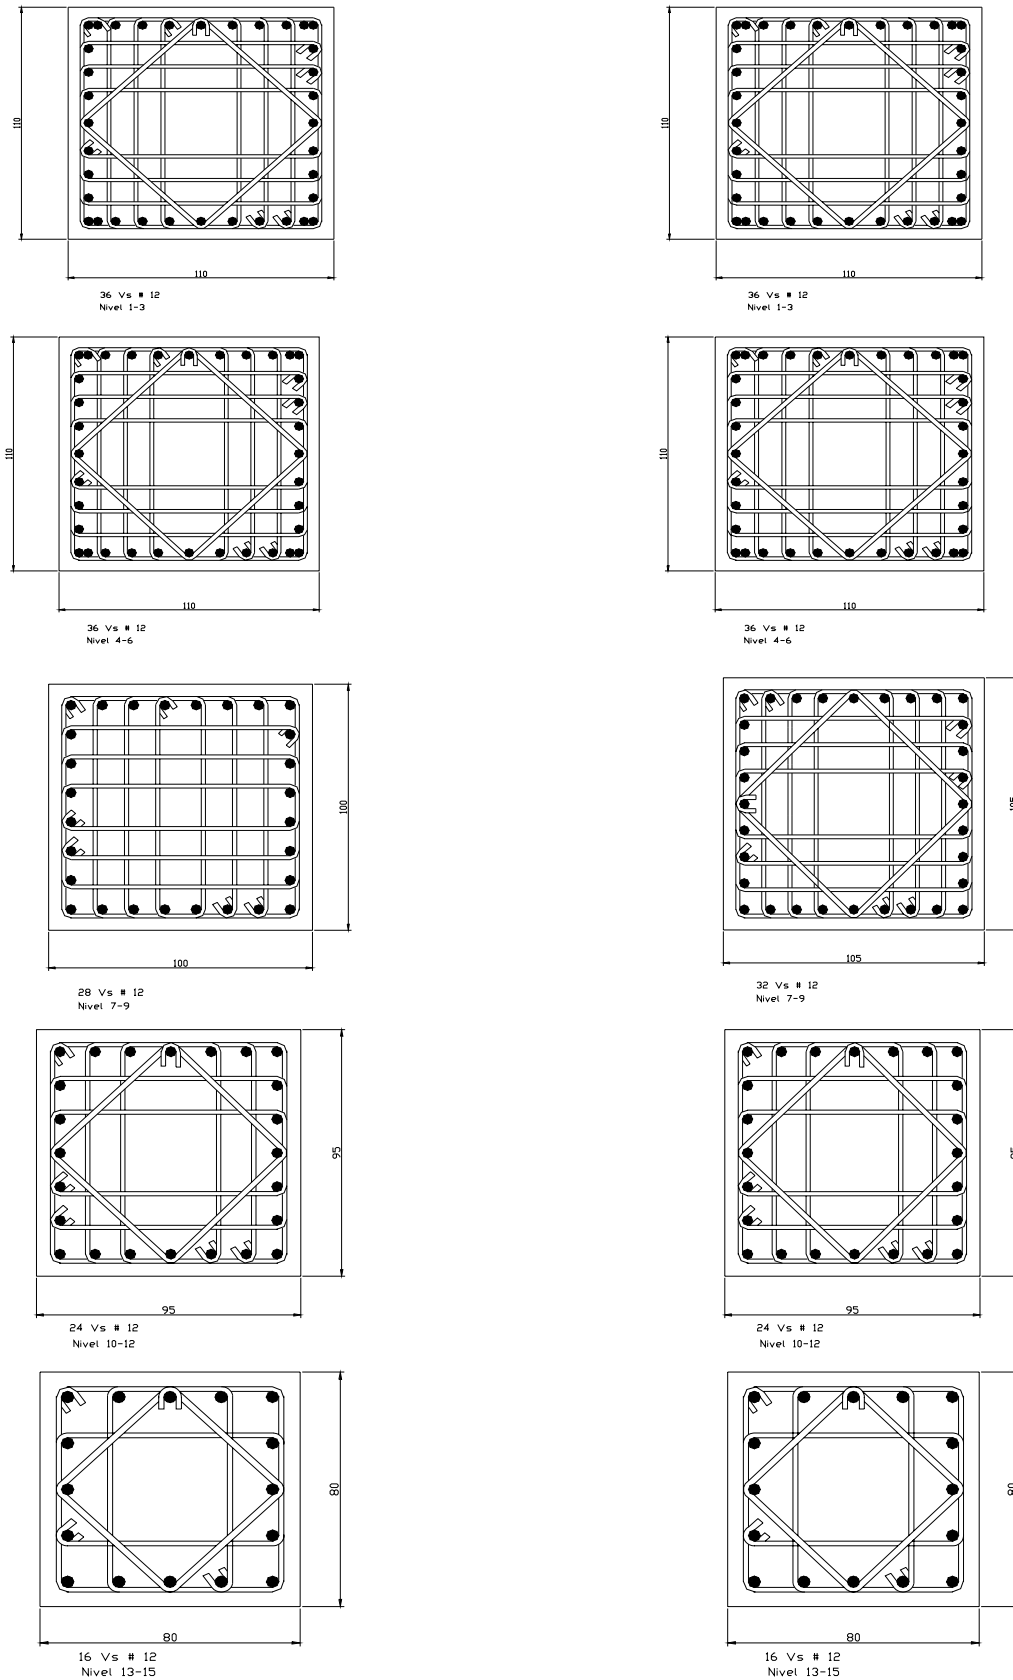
Detallado de Columnas de Marcos Exteriores e Interiores, respectivamente, en Dirección X e Y para el Edificio B.
